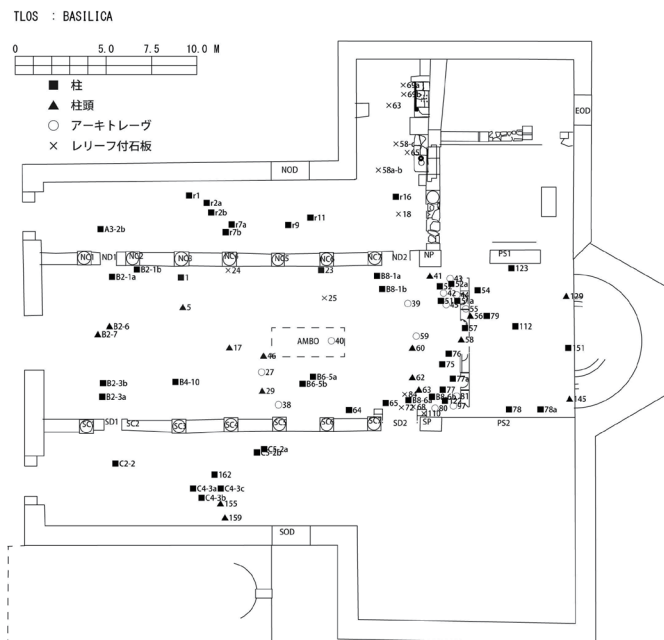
平面図と主要部材の出土箇所（平面図作成：太記祐一）
